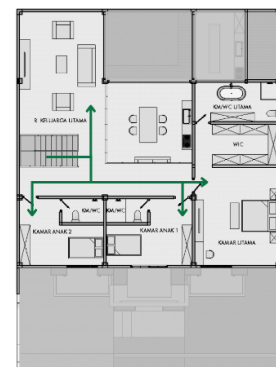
Alur Sirkulasi Sekunder Privat Lantai 1
